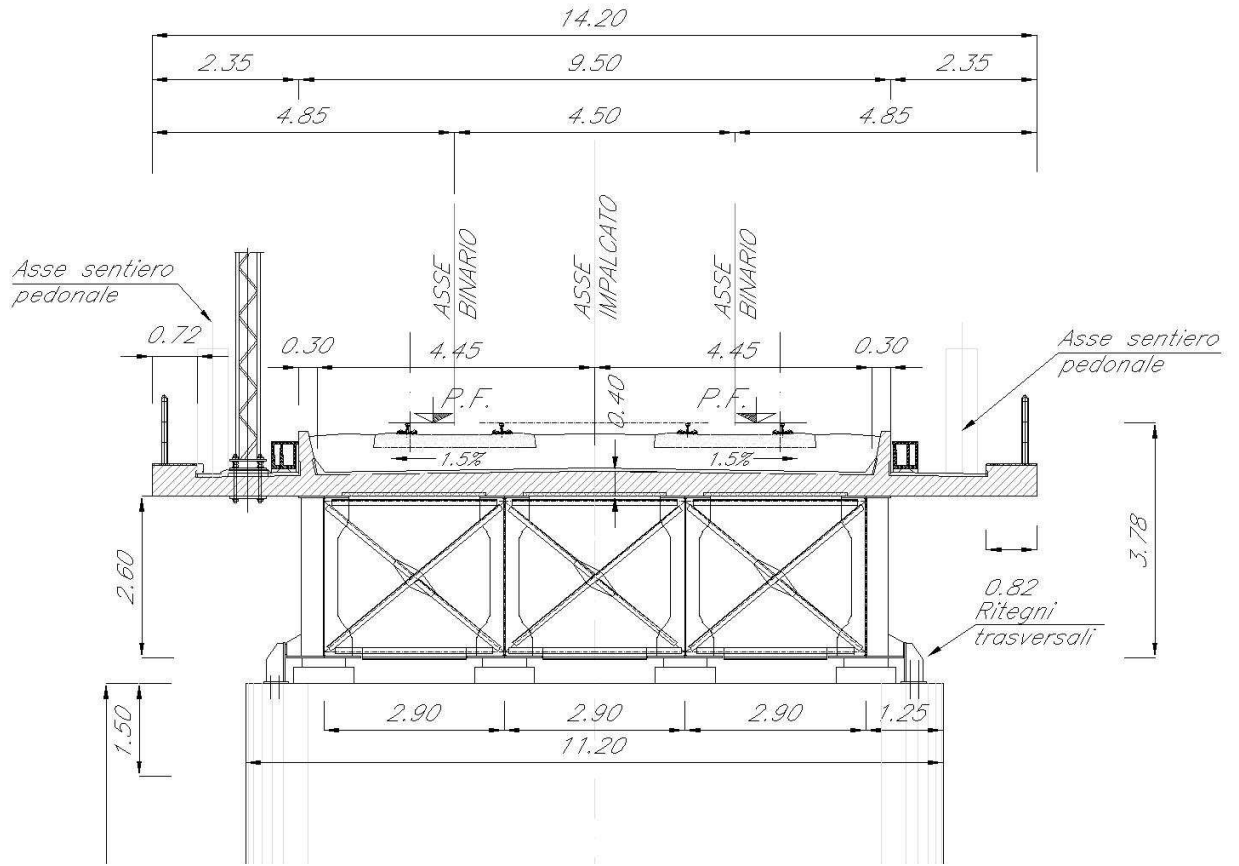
Sezione trasversale impalcato a struttura mista acciaio/cls.
